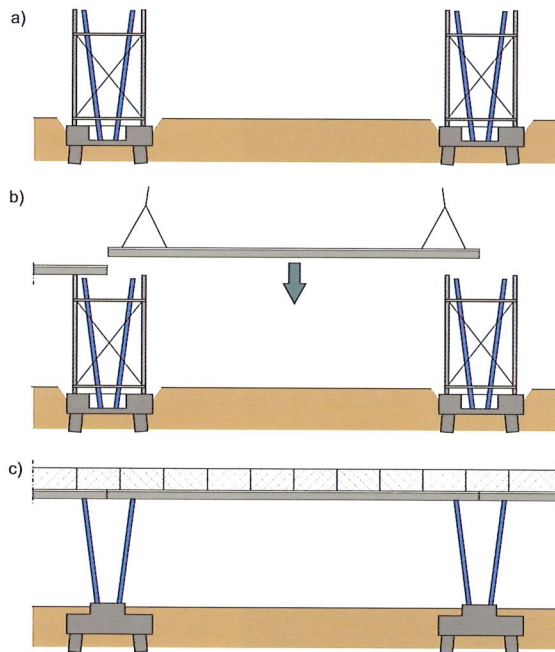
Hauptarbeitsschritte bei der Brückenmontage: a) Aufbau der Rüsttürme und Stahlrohrstützen, b) Einheben der Überbauten und Ausrichten auf den Rüsttürmen, c) Betonieren der Fundamentaussparungen [16]
